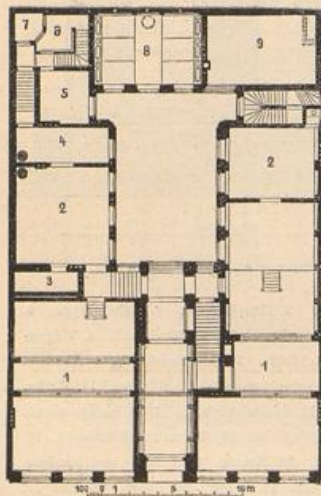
Grundriss vom Erdgeschoss.
